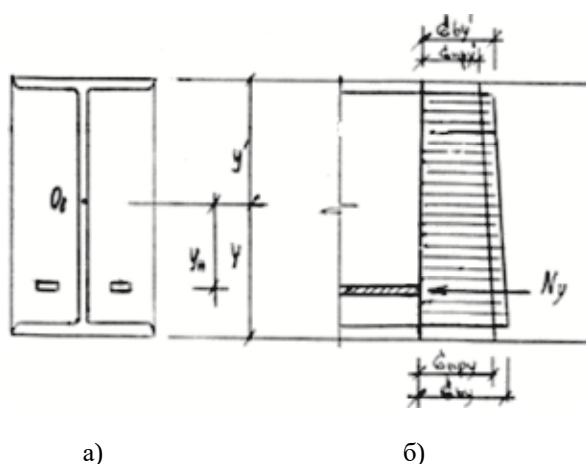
Напряженное состояние в сталежелезобетонном сечении от усадки бетона:
